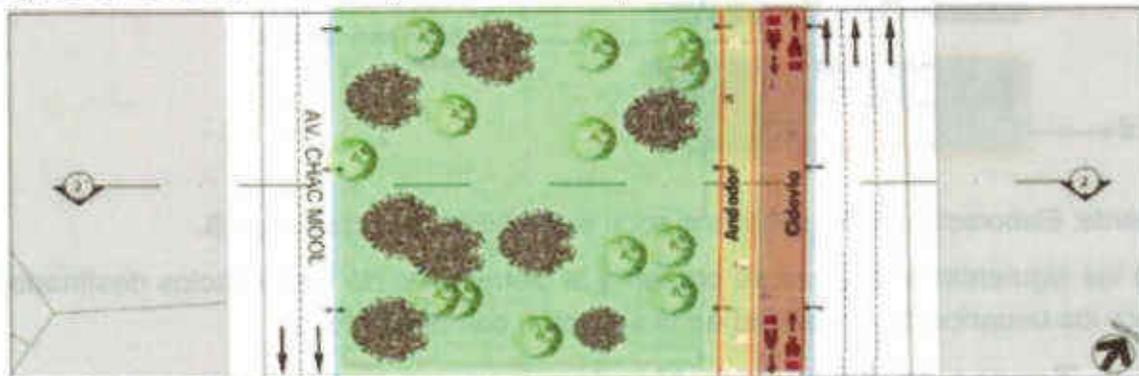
Situación con Proyecto: Corte de planta de la 2a Av. Chac Mool.
